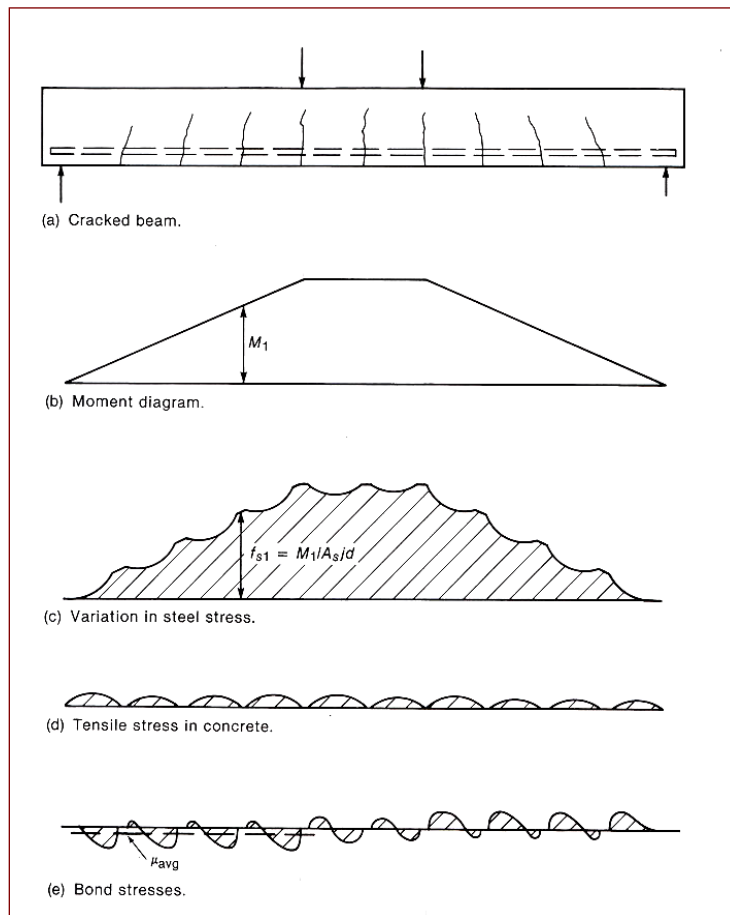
Esfuerzos en el acero, el concreto y por adherencia en una viga agrietada.
